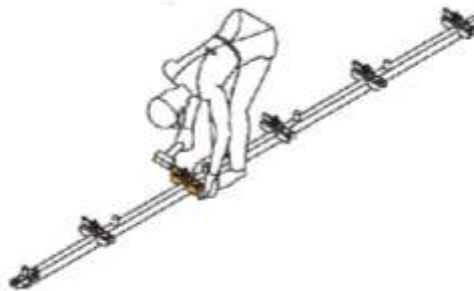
Demonstração da colocação dos cabeçais nas longarinas
